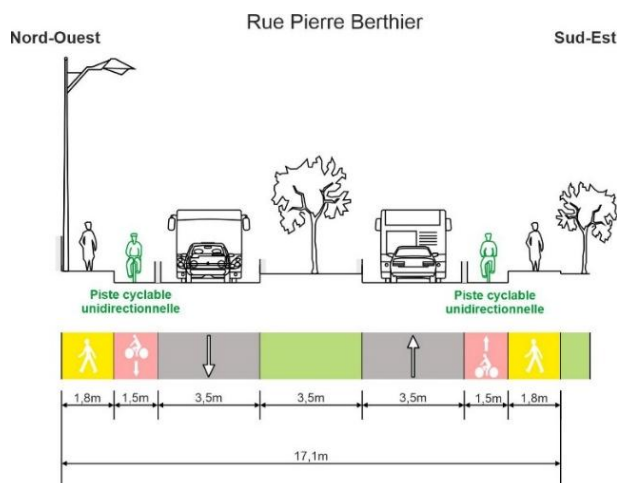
Profil en travers rue Pierre Berthier (Section Ouest)
